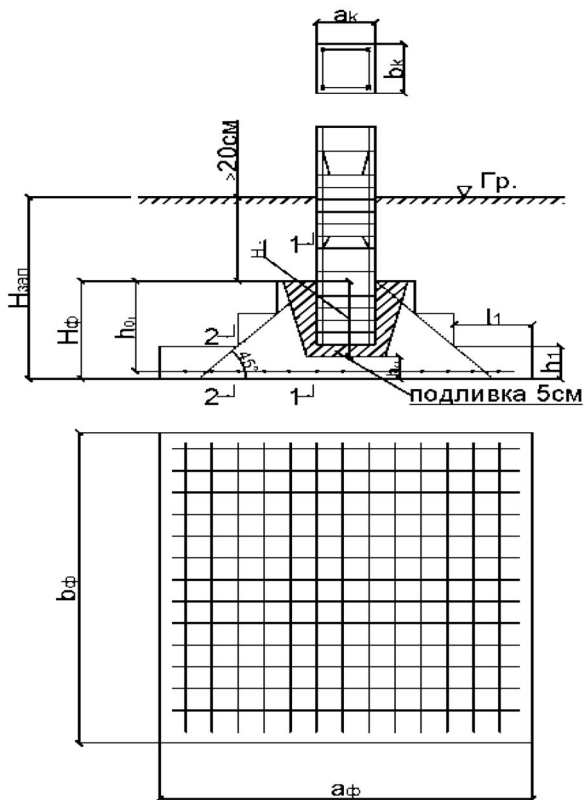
Схема армирования монолитного фундамента стаканного типа
